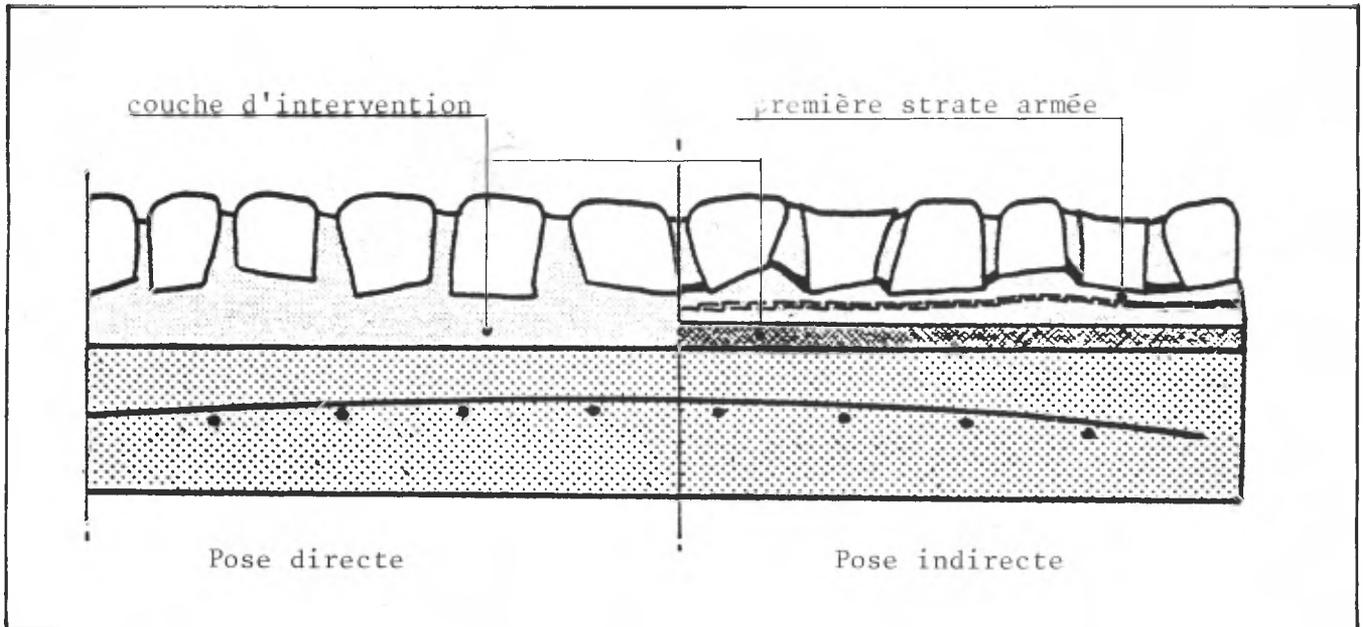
Mosaïque transférée sur une dalle de ciment armé avec couche d'intervention.
